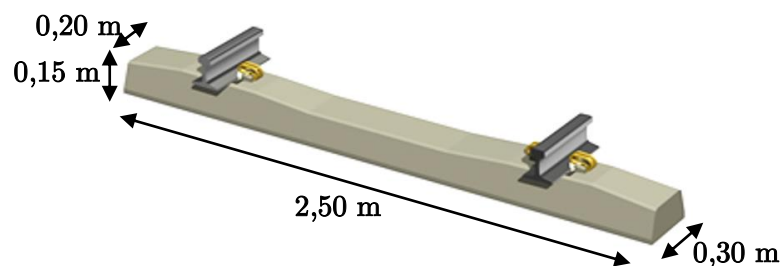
Pormenor da via e da ligação carril-palmilha
